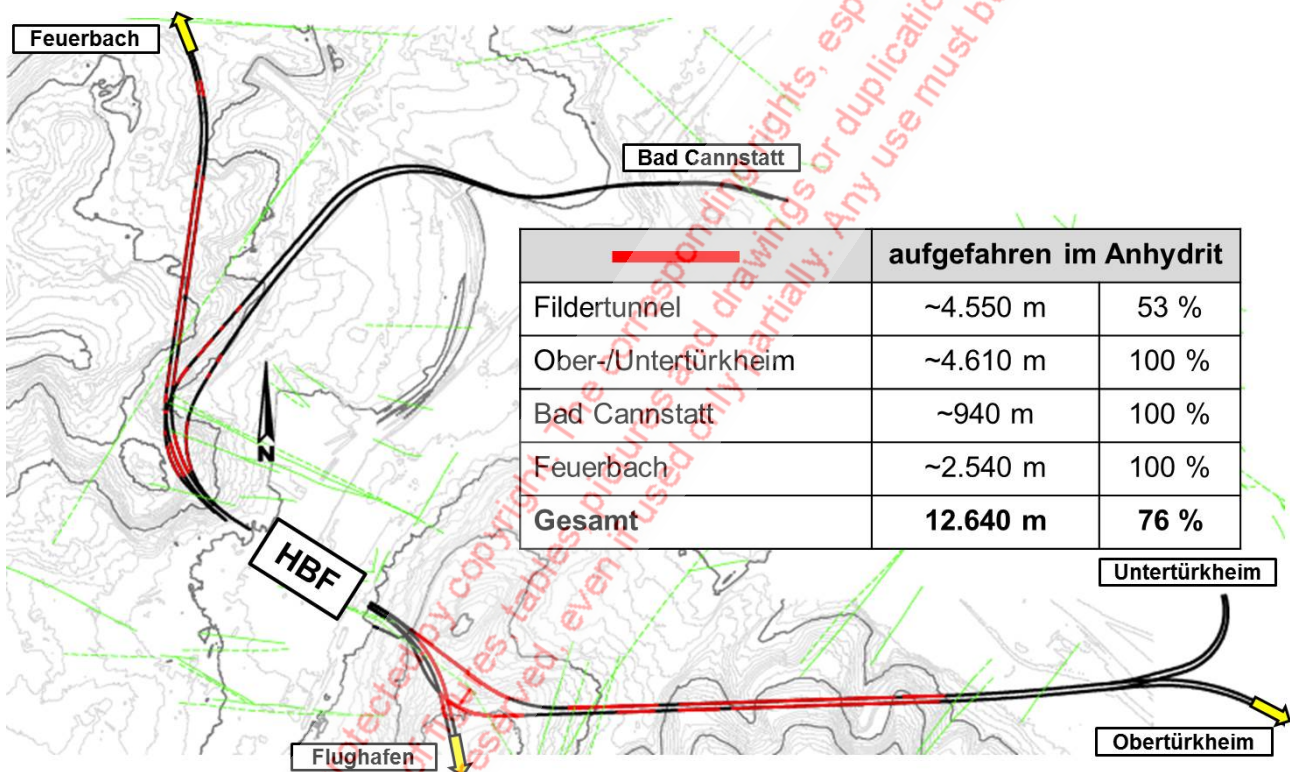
Stuttgart 21, Tunnel im Anhydrit (Stand 01.06.2018)
